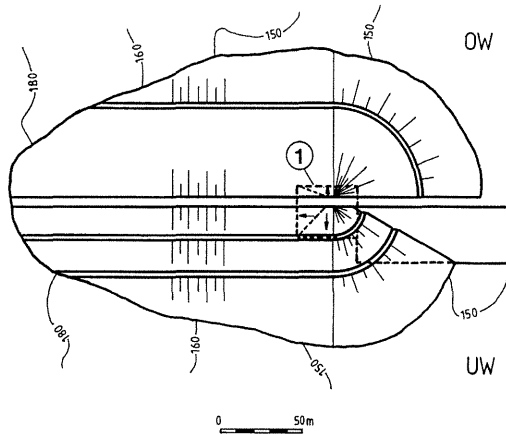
Entwurf des Anschlusses mit in den Kern hineinragendem Betonbauwerk (1)
